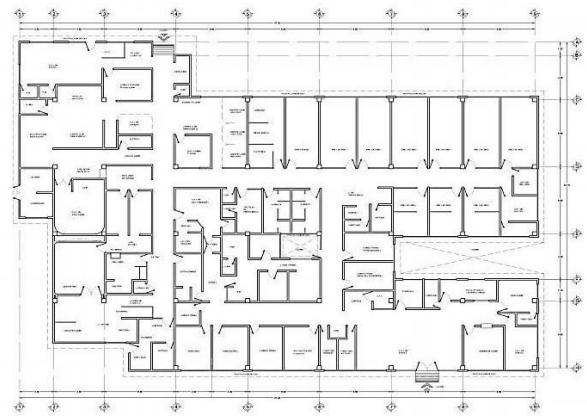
Plano Arquitectónico del Hospital General de Huichapan, Fuente propia.
